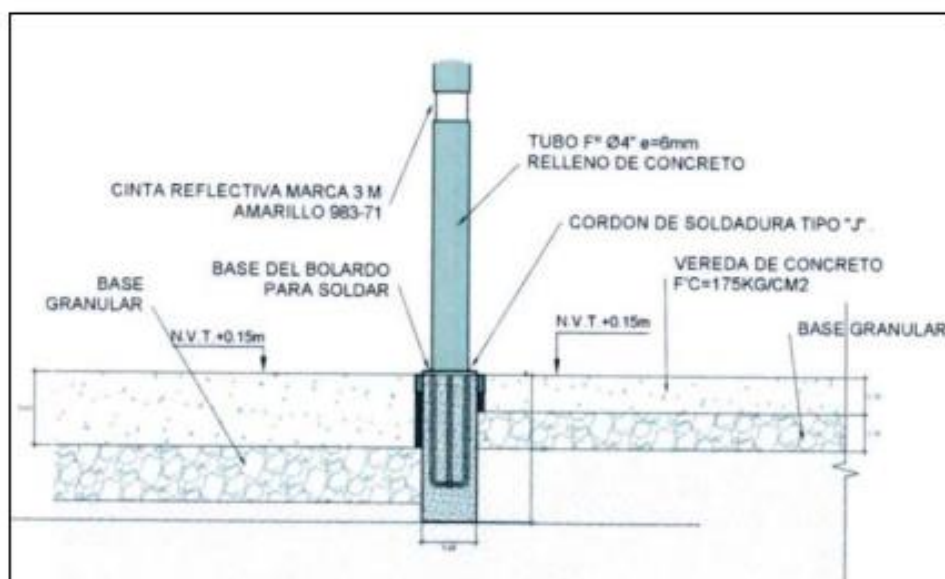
Propuesta cordón de soldadura en bolardo.
